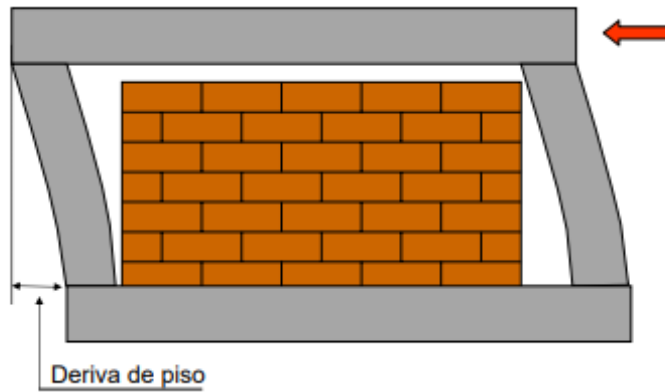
Falla por tracción indirecta en un muro confinado, fuerza paralela al plano.
